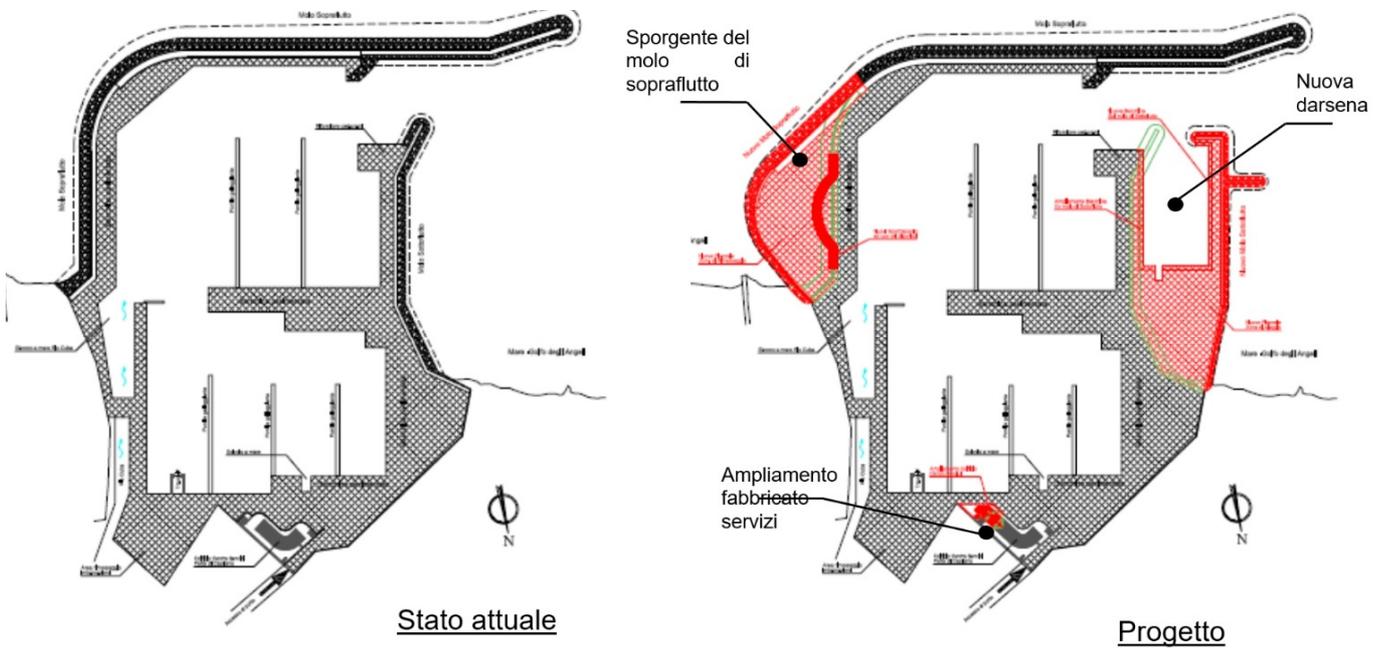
Confronto dell'assetto planimetrico del porto (stato attuale e progetto)
